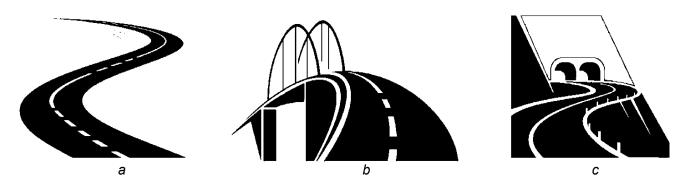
Разбивка трассы: a – участок дороги; b – мостовое сооружение; c – тоннель Fig. 2. Breakdown of the route: a – road section; b – bridge structure; c – tunnel
